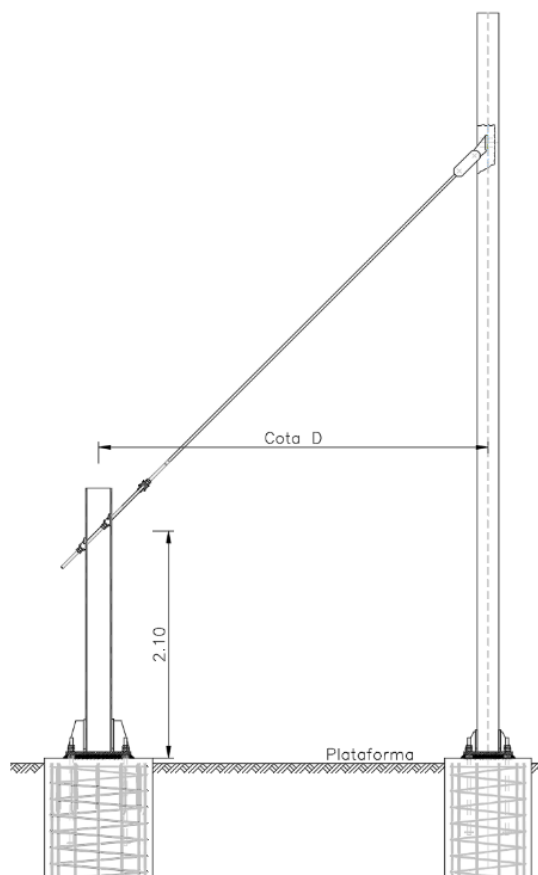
Espiamento sobrelevado – Exemplo de fundação cilíndrica
